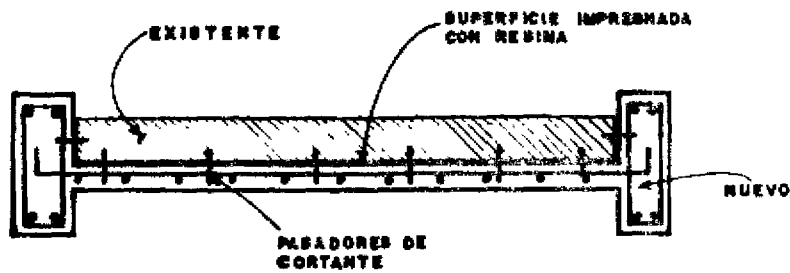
REFUERZO PARA AUMENTAR CAPACIDAD A FLEXION EN MURO EXISTENTE
